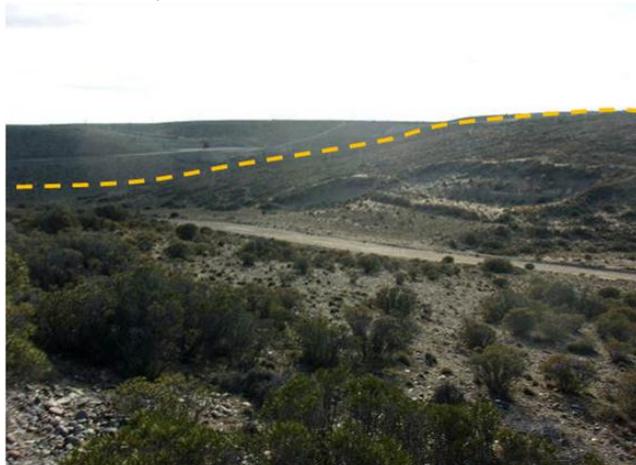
Fotografía III.C-95. Línea eléctrica (naranja). Foto en dirección Oeste.
